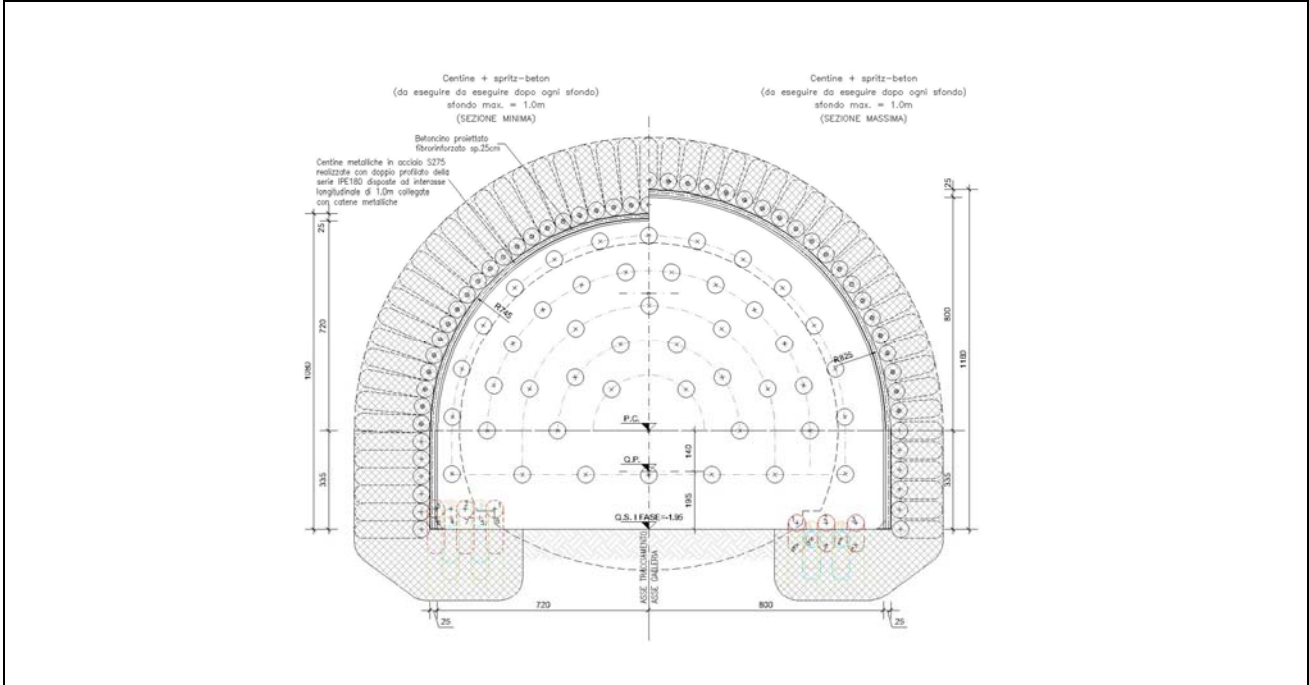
Sezione di scavo tipo GD-C2 - Sezione trasversale
